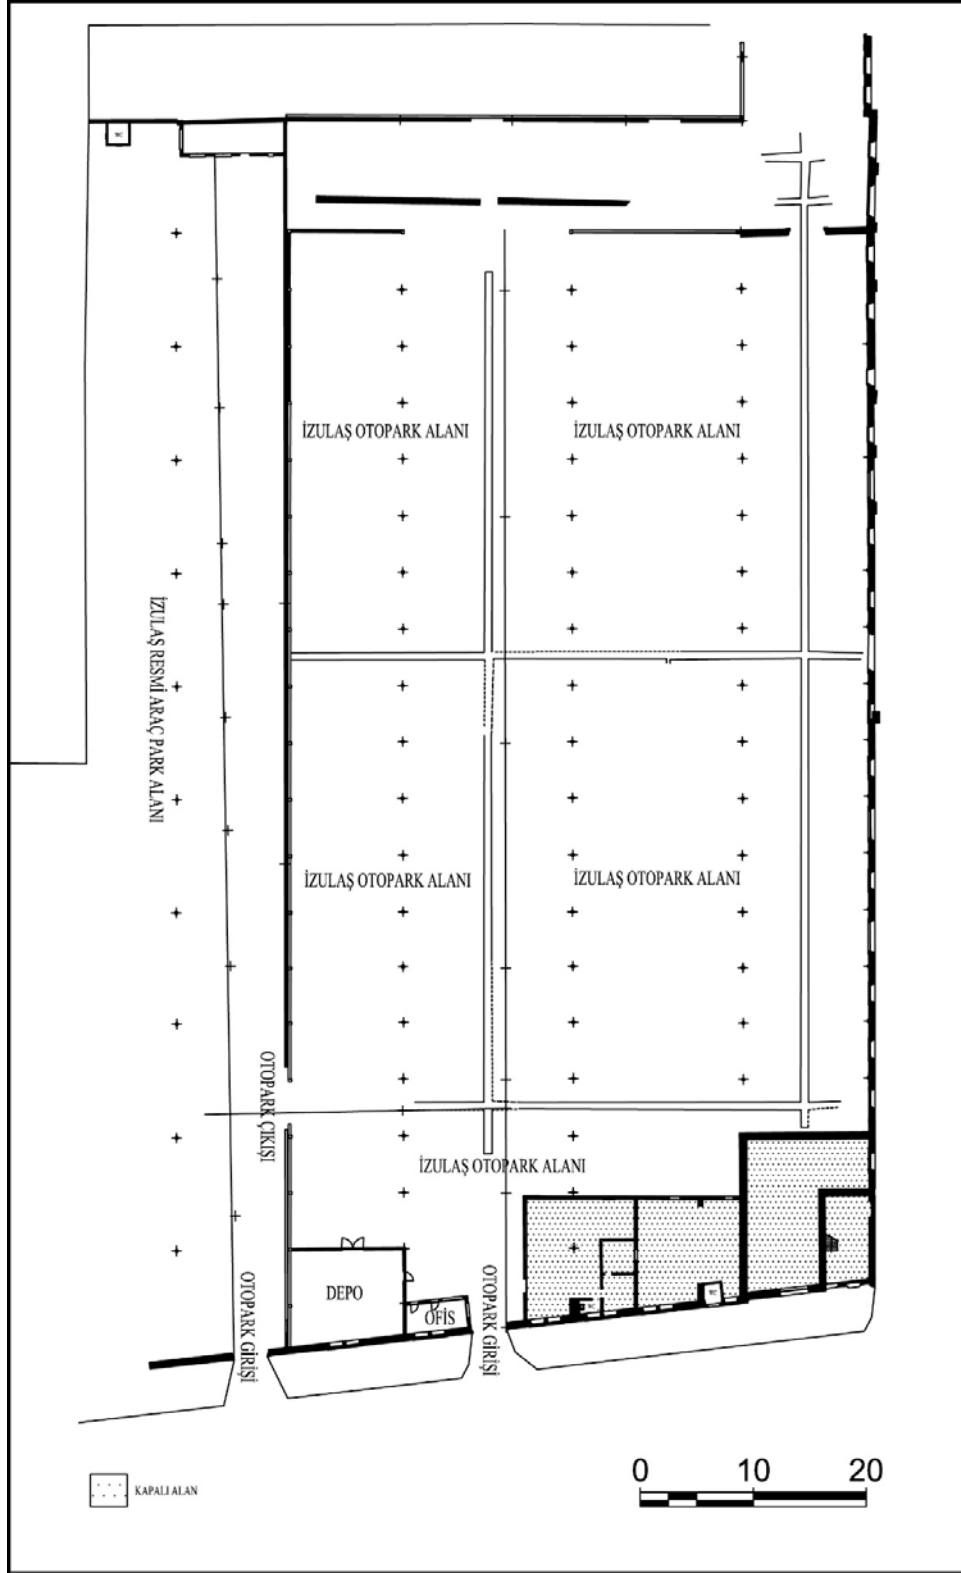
Büyük Hol Binası'nın Plan Şeması
